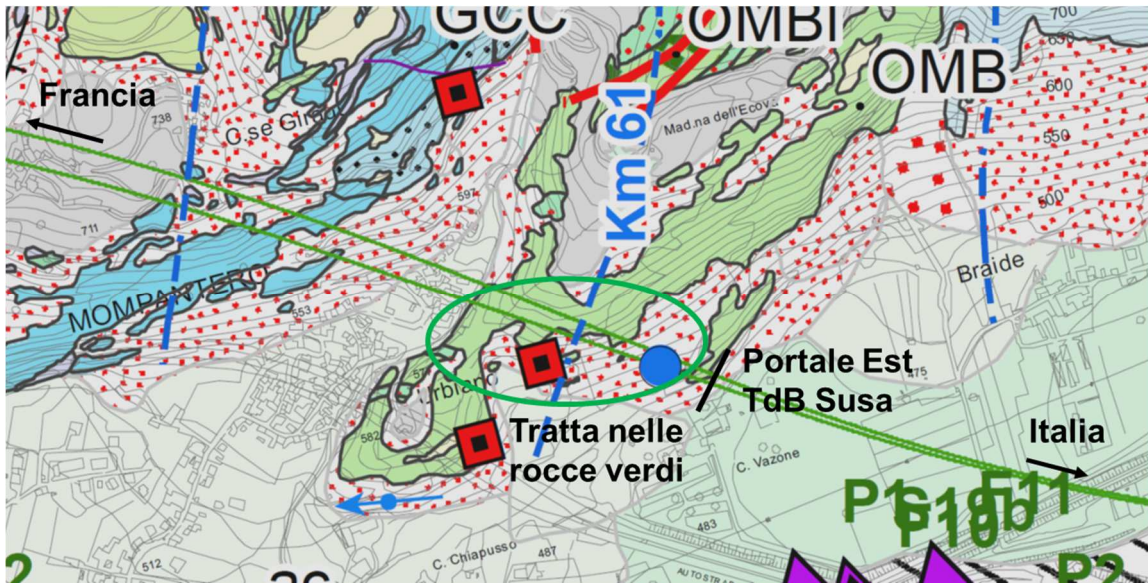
Planimetria generale della zona interessata dalle rocce verdi
